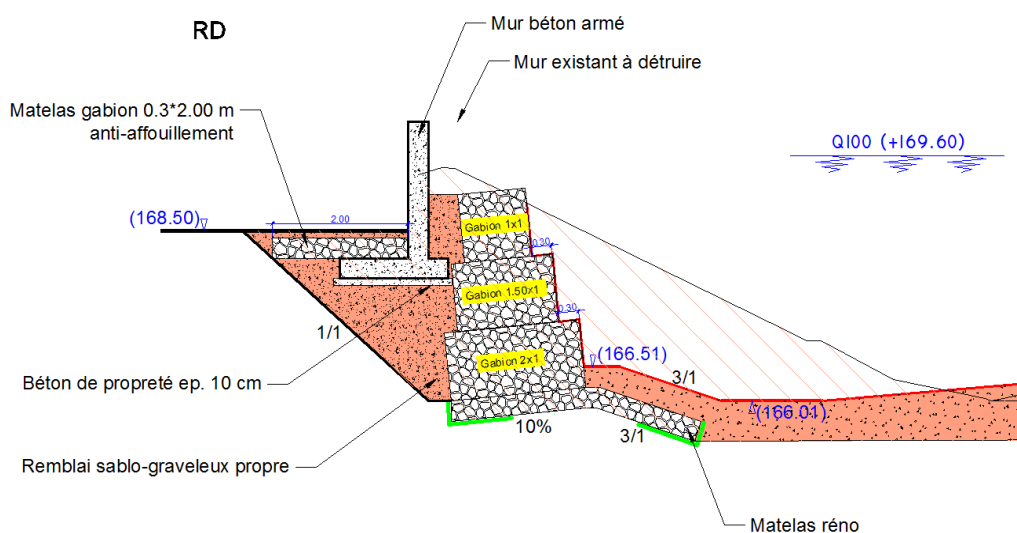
Coupe type de la digue RD aval sur le secteur des Célestins à Oullins
